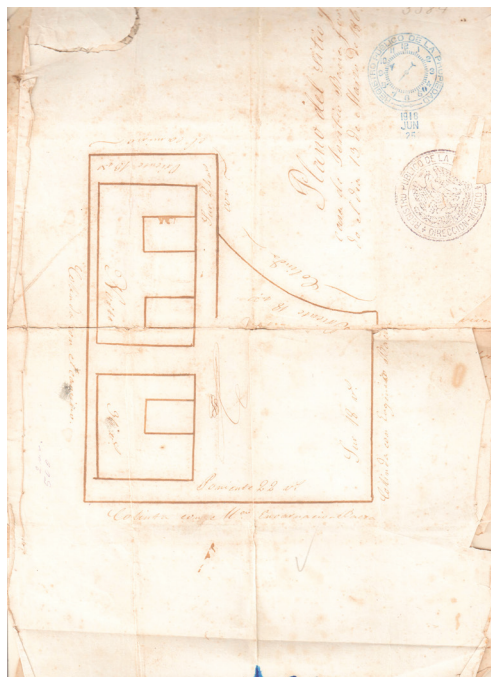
Plano de la Casa de Tepepan. Acervo personal de Rosa María Guzmán, 13 de marzo de 1861.
